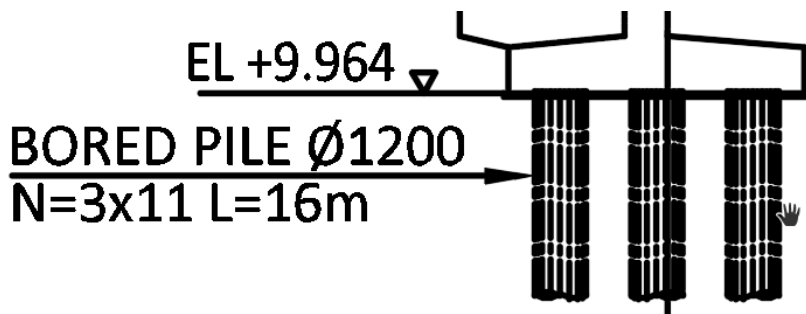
Letak Pondasi Bore Pile pada Abutment A1
